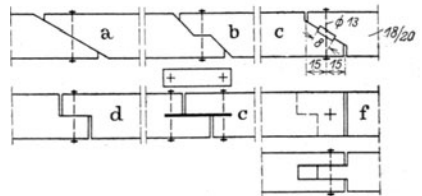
Gelenkausbildungen für Pfetten. Ausführung a wenig zu empfehlen. Bei c auch Schräganordnung des Bolzens.
